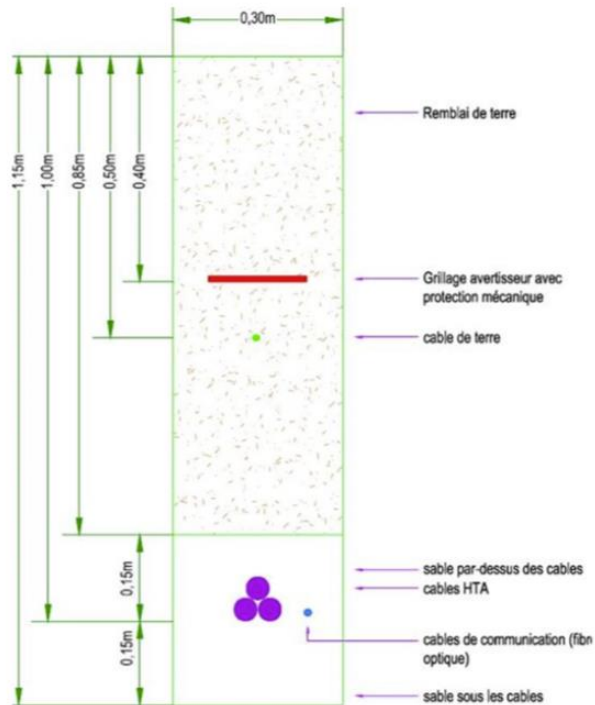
Coupe d'une tranchée pour implantation des câbles au sein du projet
